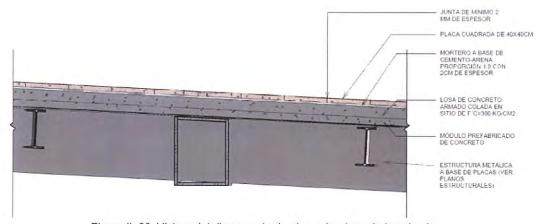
Vista a detalle en corte de piso sobre losa de la calzada.
